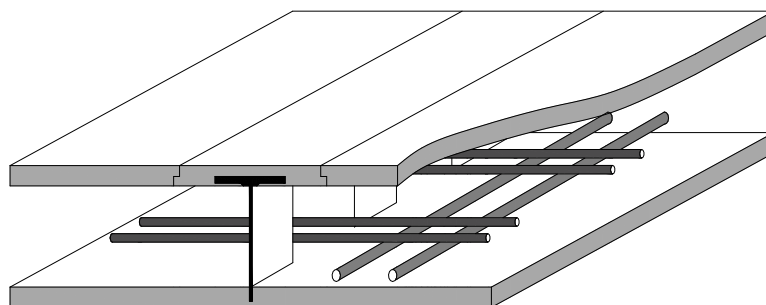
Сталежелезобетонное перекрытие с жесткой арматурой в виде сварных профилей открытого коробчатого сечения [9]
